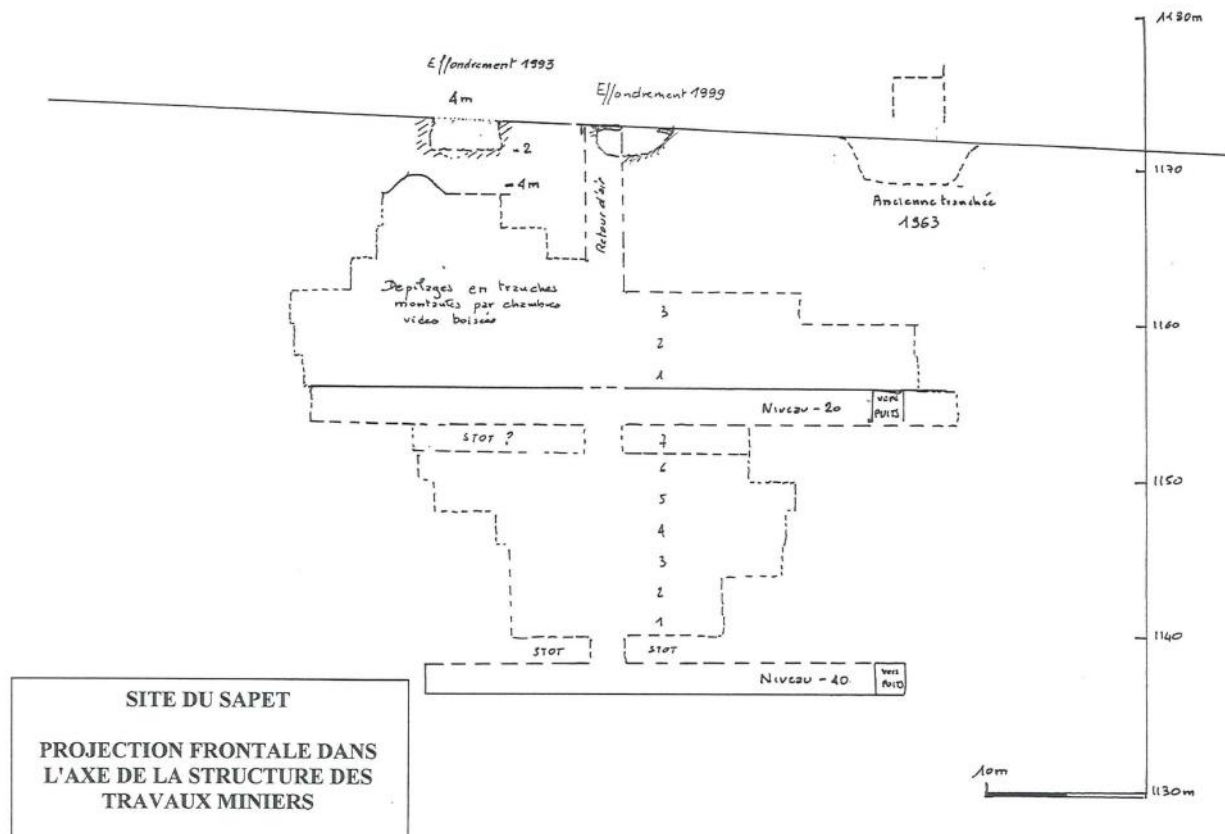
Schéma des travaux miniers réalisés sur le site Le Sapet (source Areva [3])
